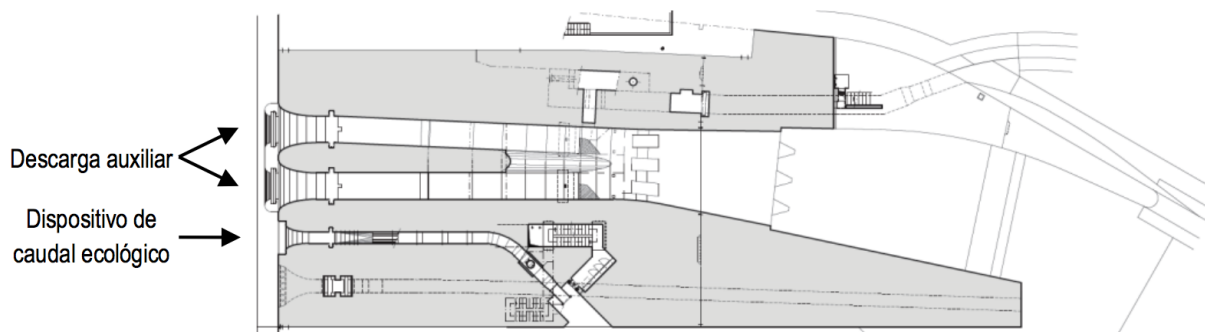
Barragem de Pedrógão. Planta pelo eixo da descarga auxiliar e do dispositivo de caudal ecológico. (Ferreira, A., et al, 2012).
